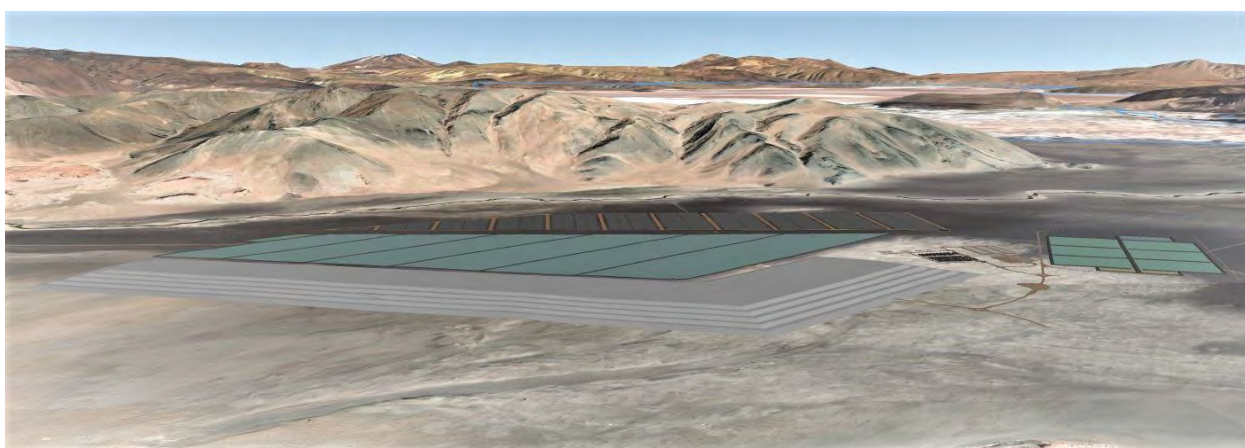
Vista de noreste a sudoeste de las piletas de evaporación, planta de procesamiento y de los acopios de sales de cosecha.
